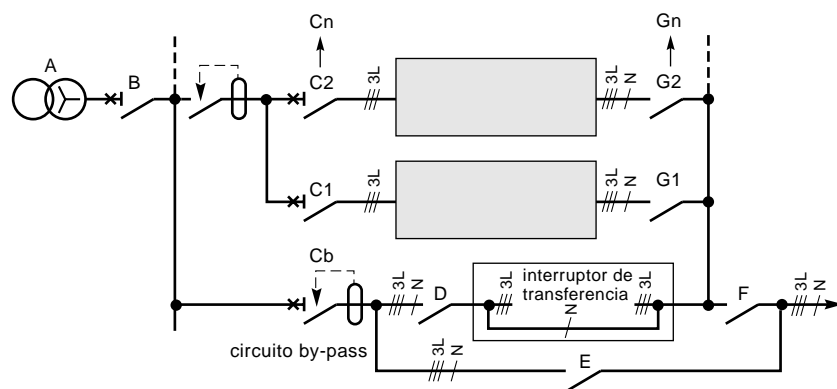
Único DDR para vigilar todas las entradas del rectificador cuando la batería es común a varias cadenas o SAI.
